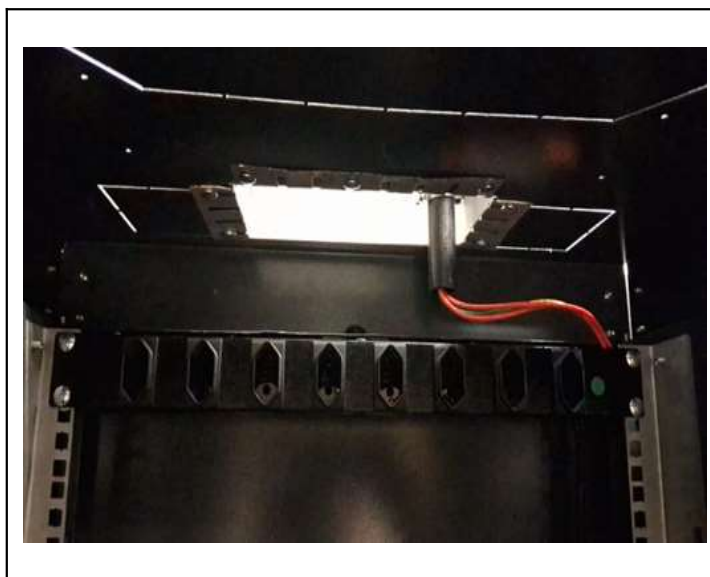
Torre 01 – 1º Pavimento – Entrada para Alimentação da Fibra
